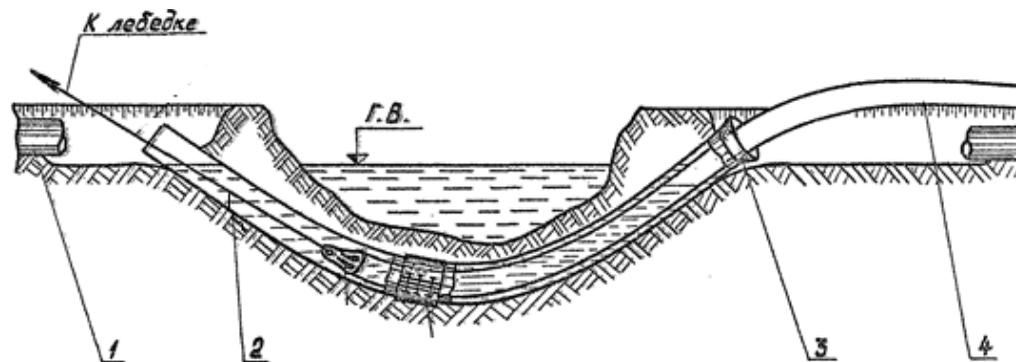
Укладка трубопровода по схеме «труба в трубе»:
